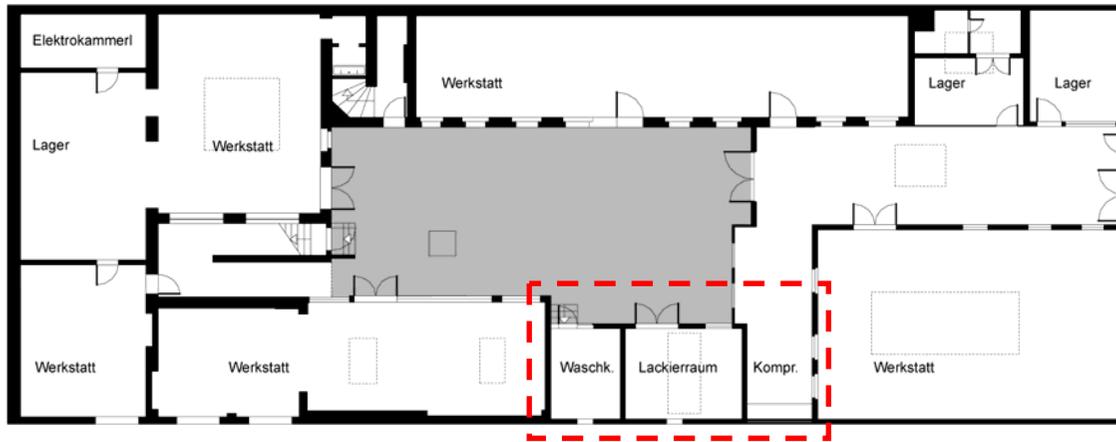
Grundriss Erdgeschoss mit Lackiererei
